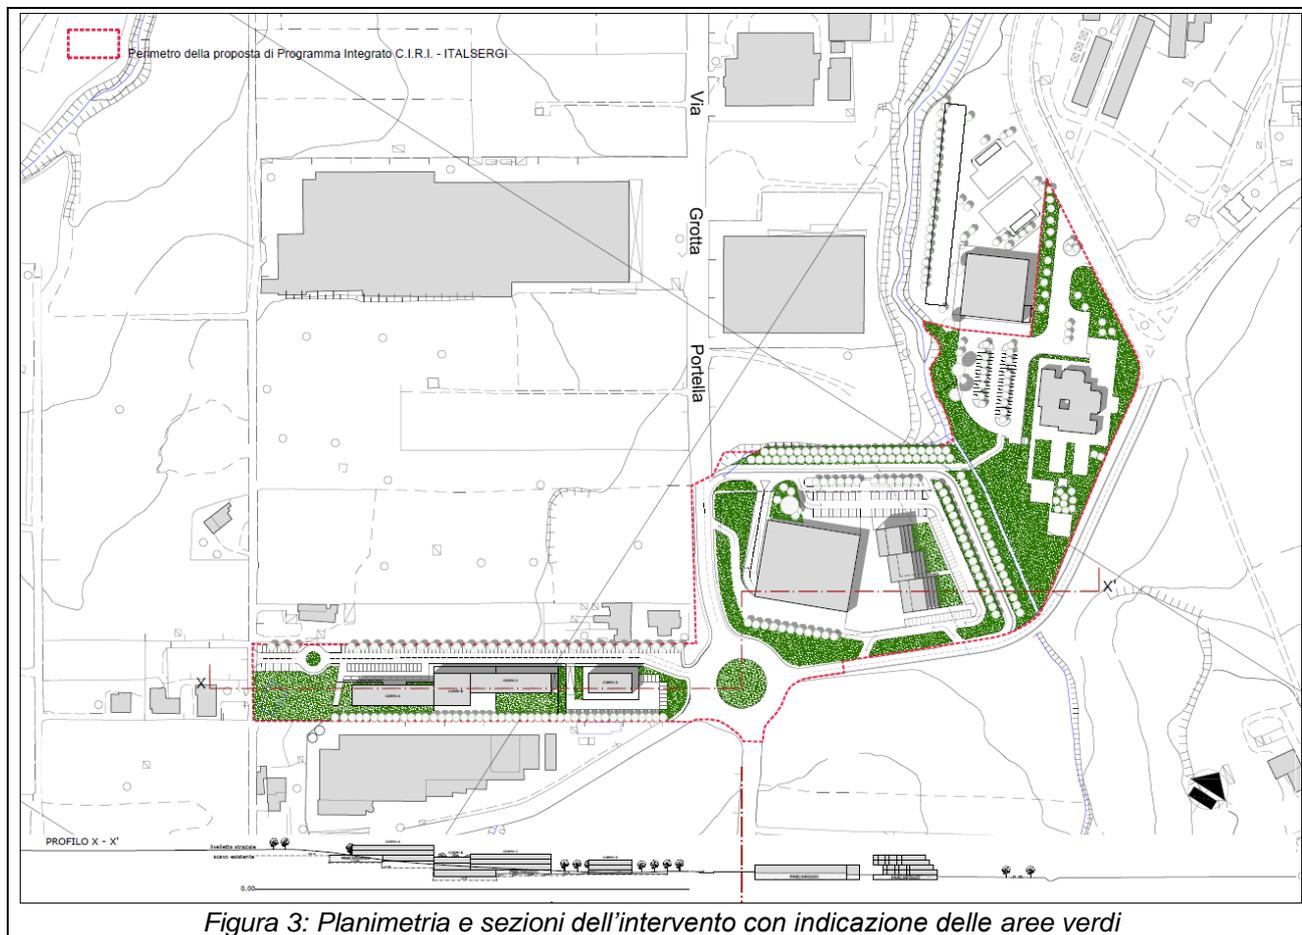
Planimetria e sezioni dell'intervento con indicazione delle aree verdi
